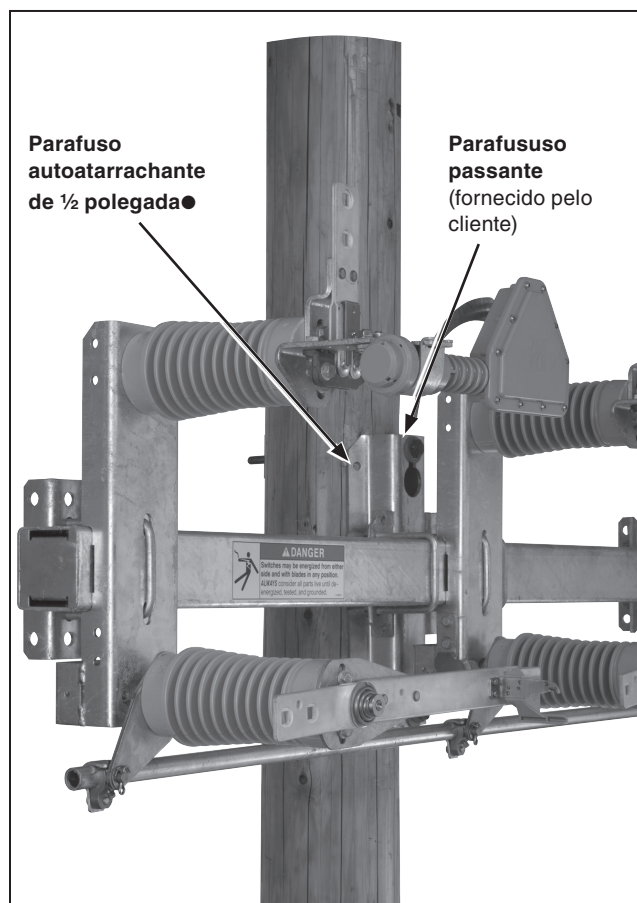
Detalhe da fixação típica do suporte de montagem (mostrada a configuração de montagem vertical. A posição invertida é similar).
